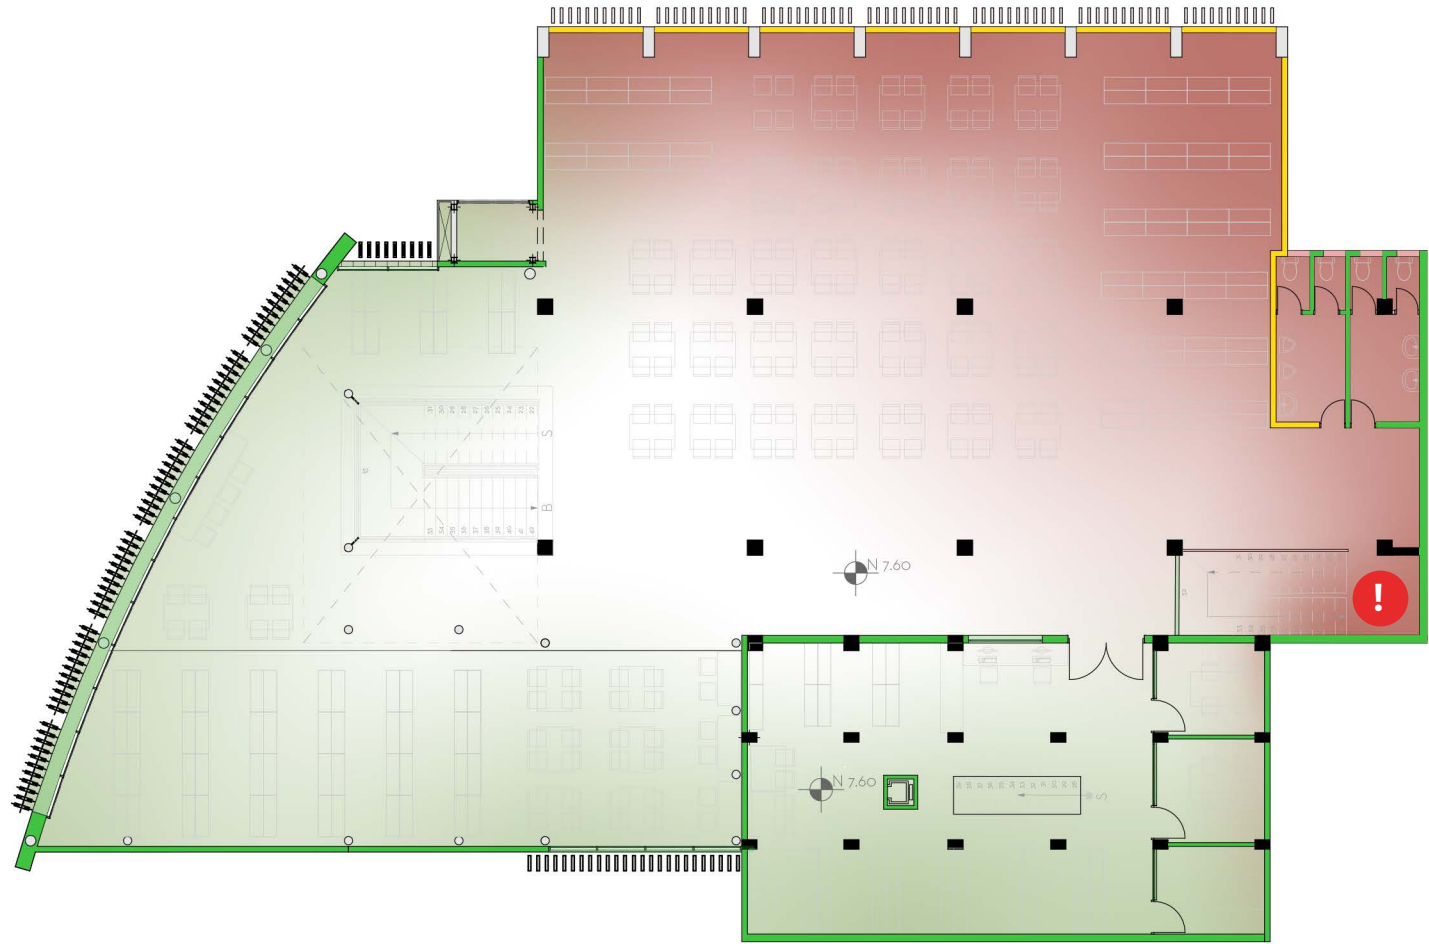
Zonas seguras localizadas en Planta Baja, Morocho & Sarmiento (2020).
